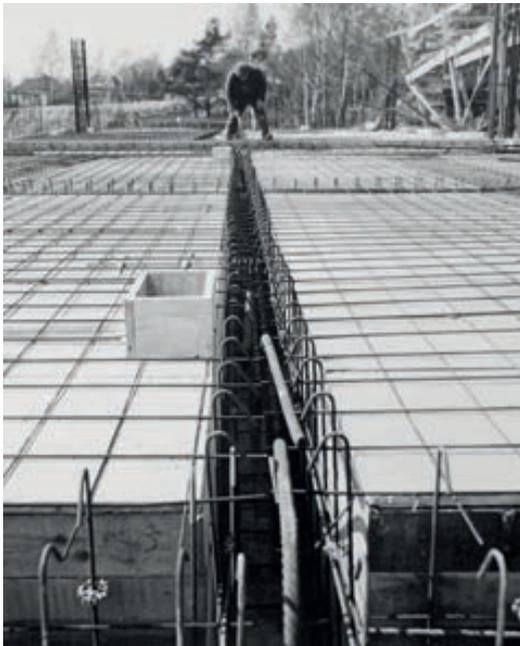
Innenraum Erdgeschosshalle, Schalungsbretter für Ortbetonarbeiten.
